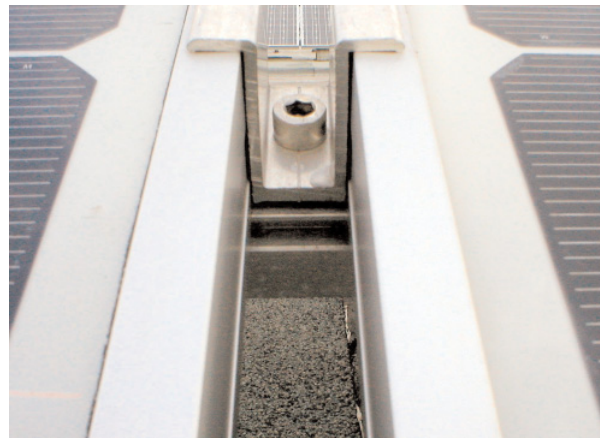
Ansicht Modul mit montierter U-förmiger Klemme
